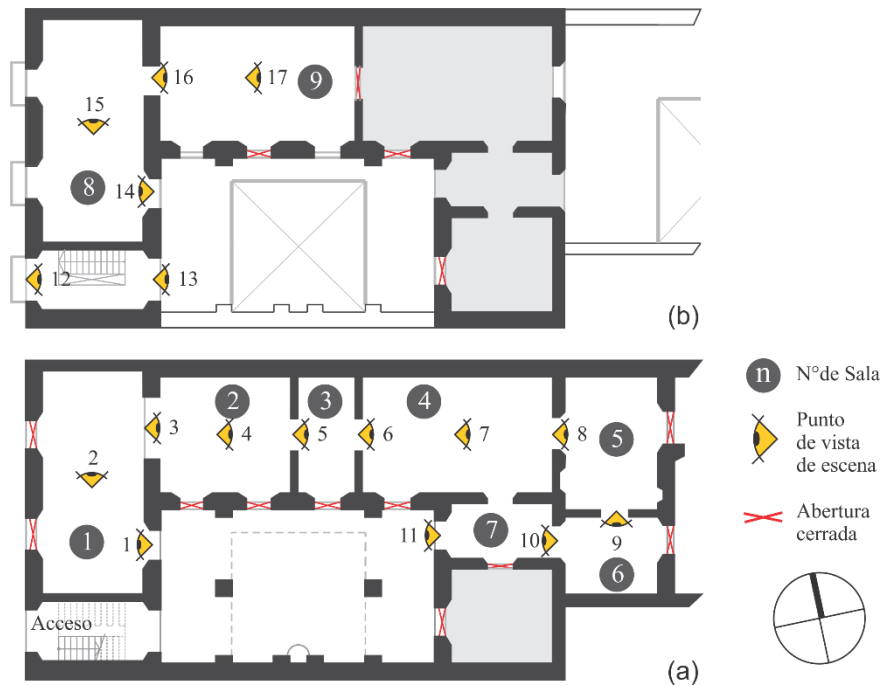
Planta baja(a) y planta alta (b) del museo y puntos de vista de escenas por sala.
